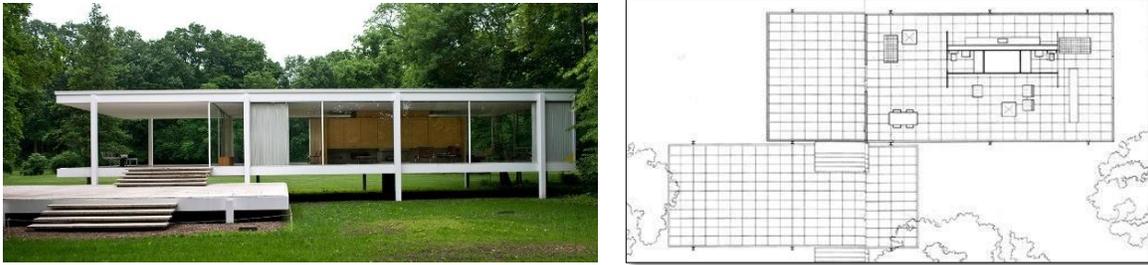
Casa Farnsworth, Mies Van de Rohe, 1951. Imagen y planta. Planta libre, estructura que permite modificación de los espacios en su interior.
